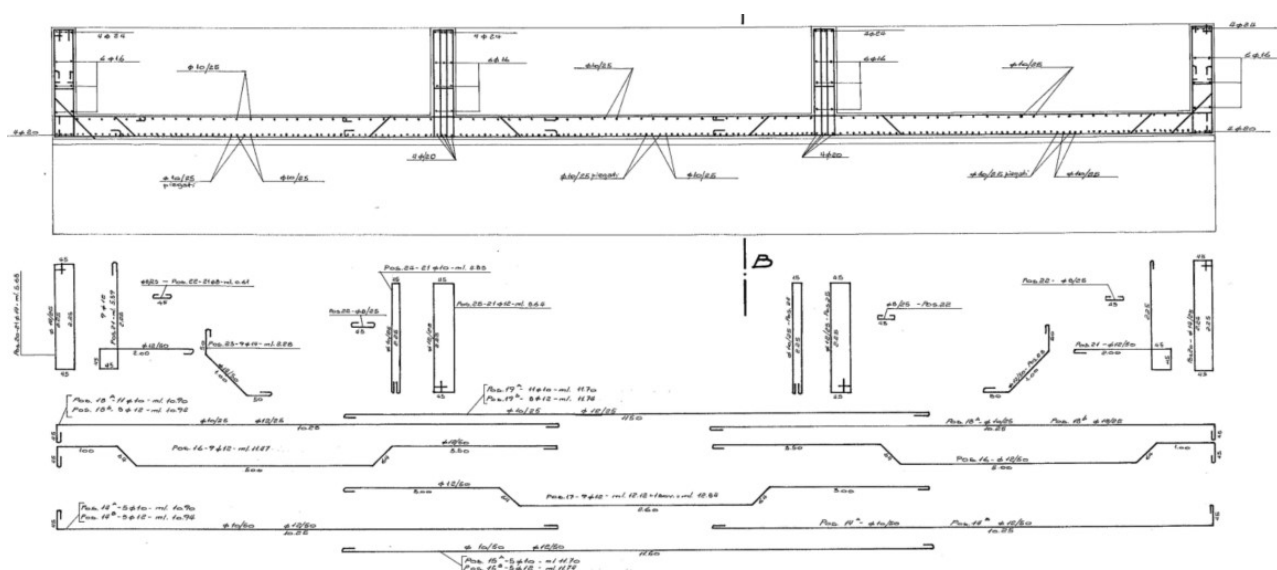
Documento as-built “Sottovia Interconnessione 1 dell’autostrada A14 al km 14+232” – Sezione orizzontale con armature spalla.
